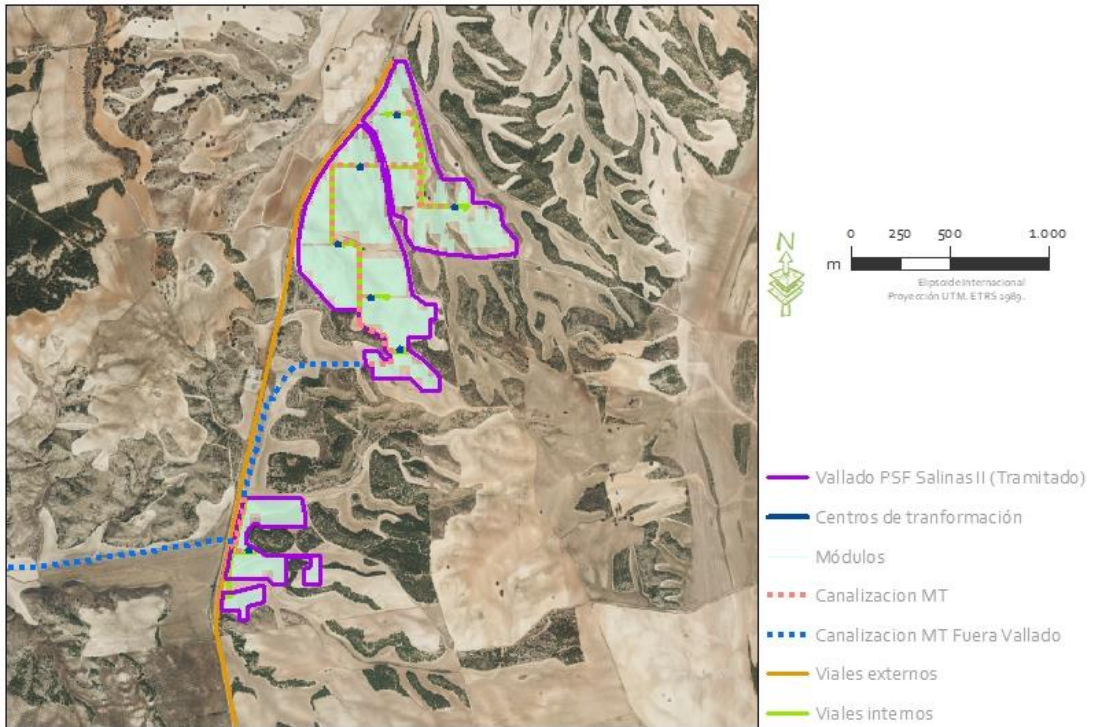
a. Diseño de la planta solar tramitada original.
